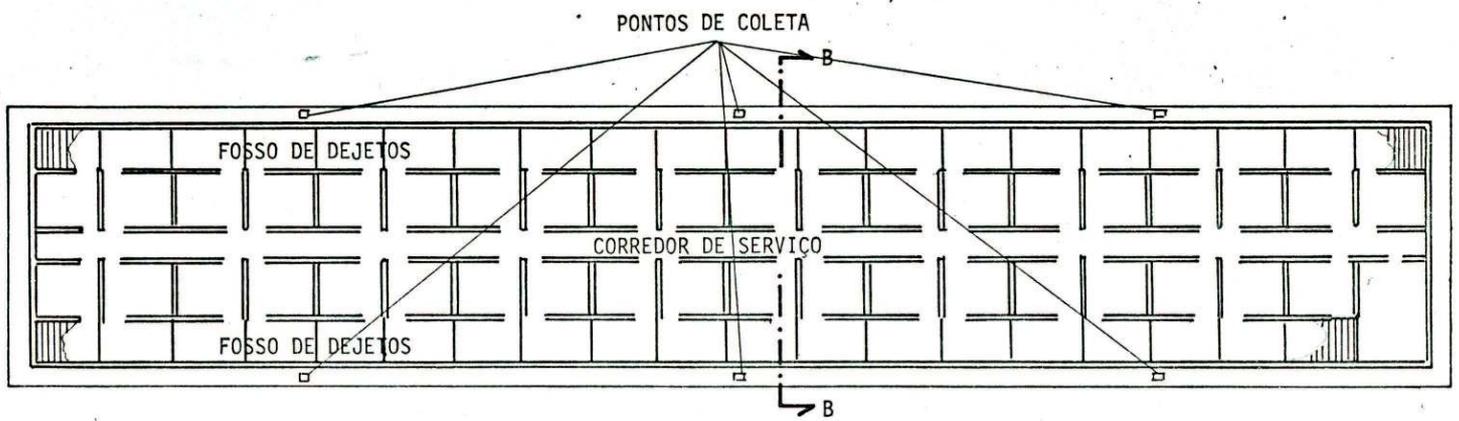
Croqui (planta baixa) de uma unidade de crescimento e terminação, com indicação dos pontos de coleta
